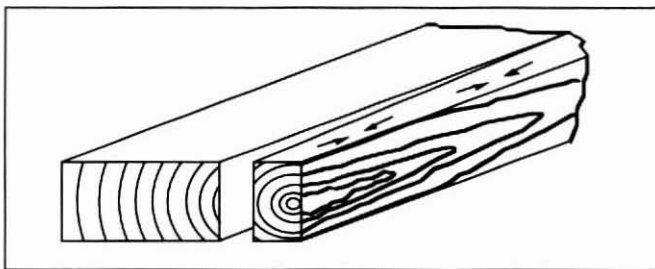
RAJADURAS CAUSADAS POR TENSIONAMIENTO INTERNO
